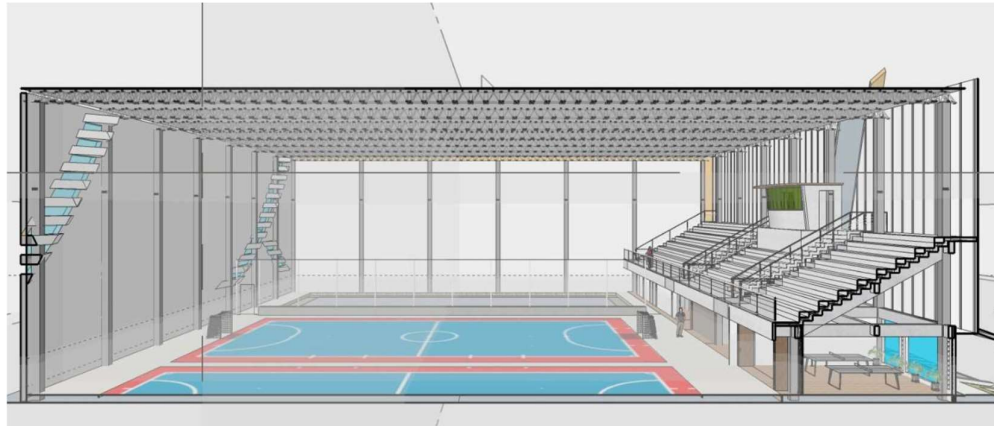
, 3.4, 3.5, dan 3.6 menampilkan sejumlah gambar perencanaan teknis, termasuk perencanaan pondasi, tampilan interior, gambar eksterior, dan bagian a-a.
